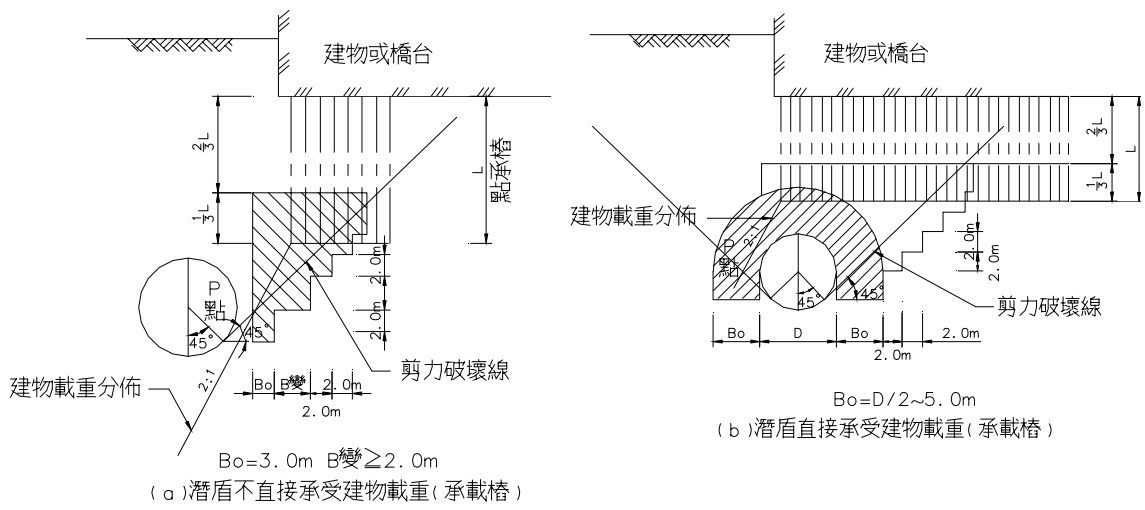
潛盾隧道施工之建物保護範圍示意圖(點承樁基礎)
